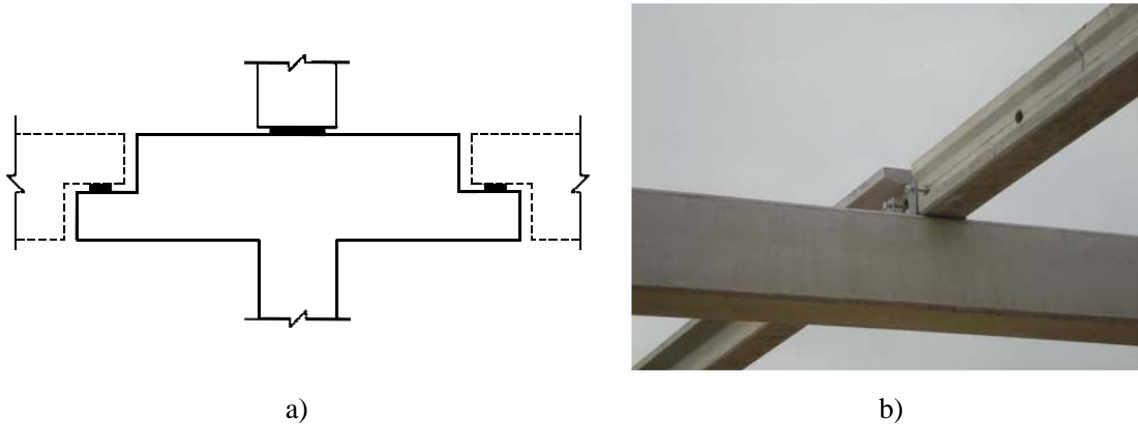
Ligação viga - viga (articulada): a) entre vigas coaxiais, b) viga secundária ligada por aparafusamento de peças metálicas à viga principal, a) [30], b) [26]
